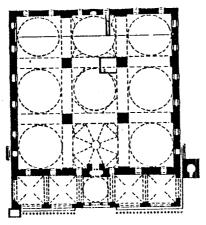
مسقط أفقي لمسجد بلخ في أفغانستان . (عن : Golombek) .
